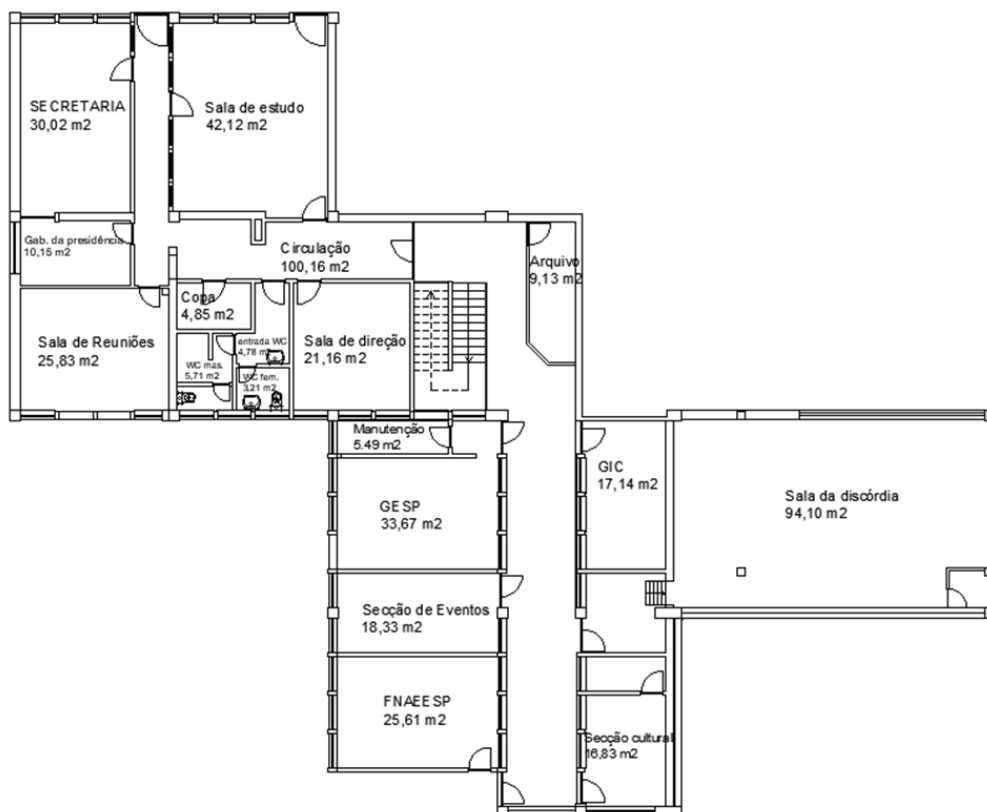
Planta em 2D do piso 0 das instalações da AE ISEC.
